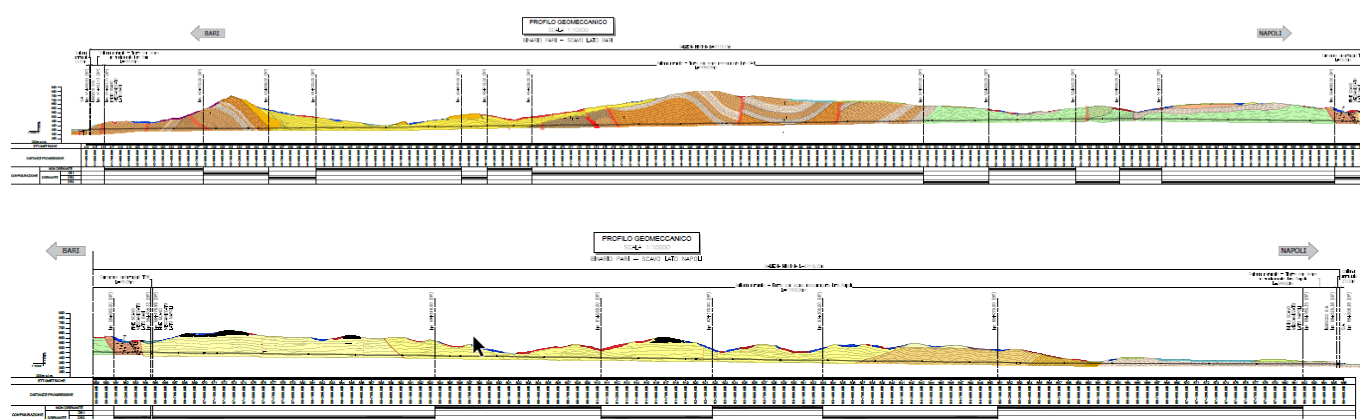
Layout tratte di applicazione sezioni impermeabili / drenanti
